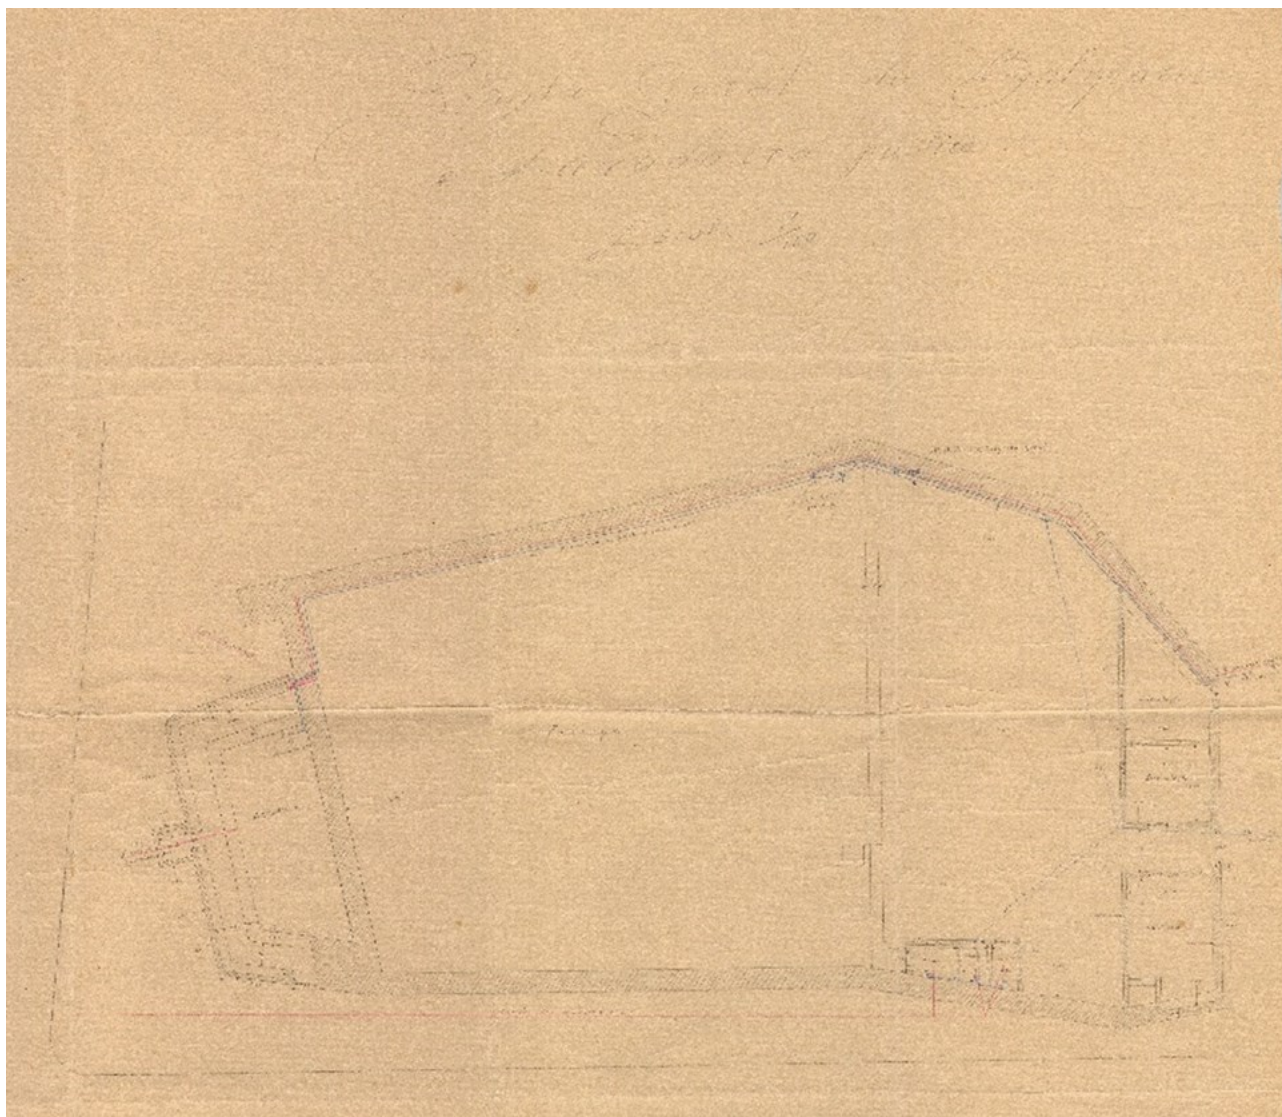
Planta Geral do Balneário e Lavadouro Público¹⁴.
